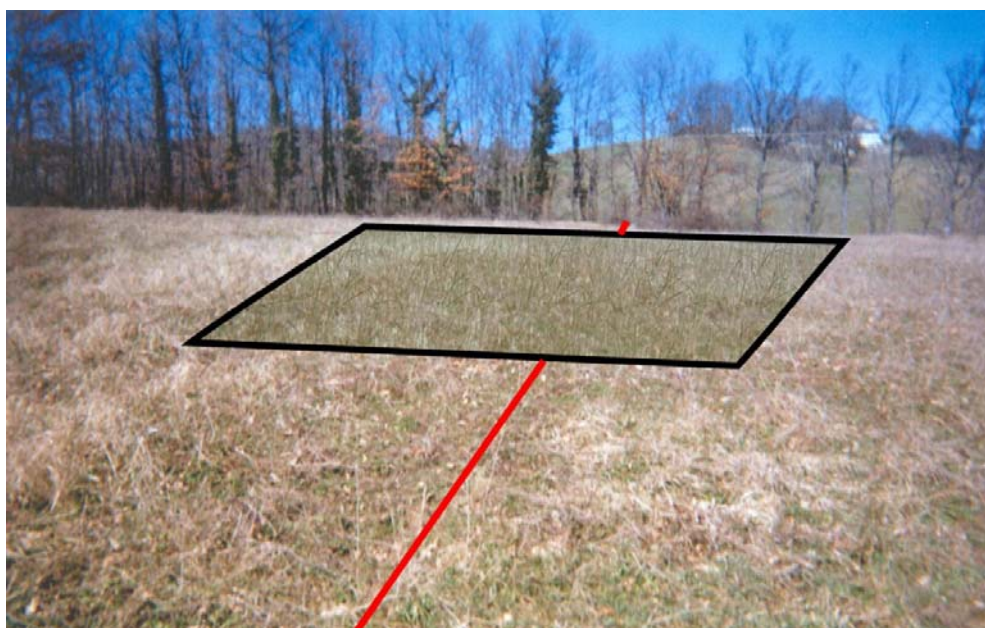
/B: Posizione alternativa dell'impianto di linea PIL n.13
